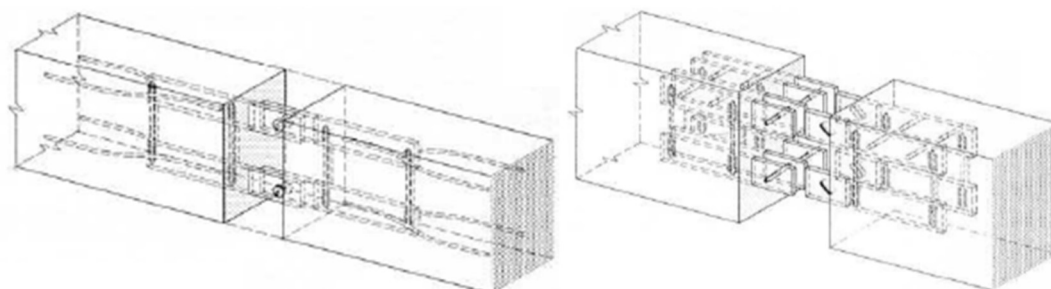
Ligação por chapas metálicas parafusadas e betonagem *in situ* (Stupré, 1981)
